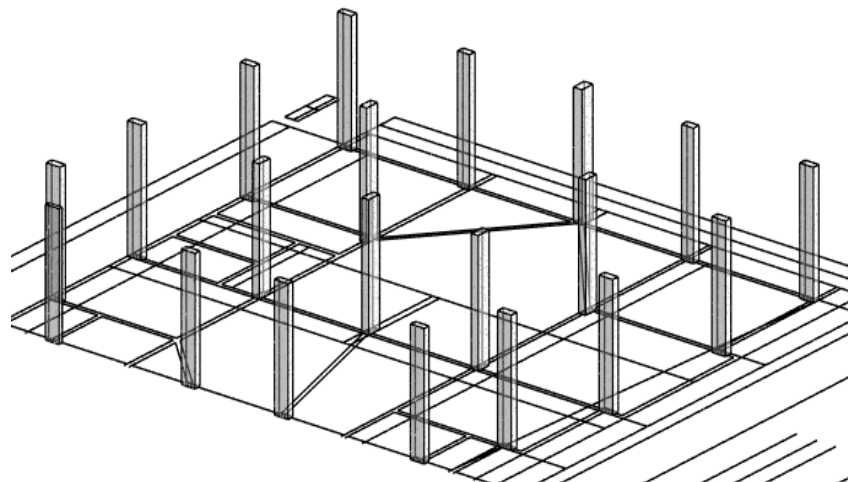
Elementos estruturais lançados sobre a planta estrutural
